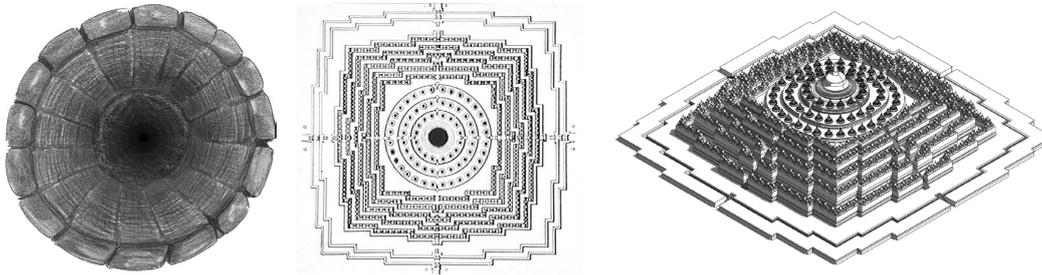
Dessin en plan d'un puits ; plan et perspective du sanctuaire de Borobudur (Vikram Lall).
